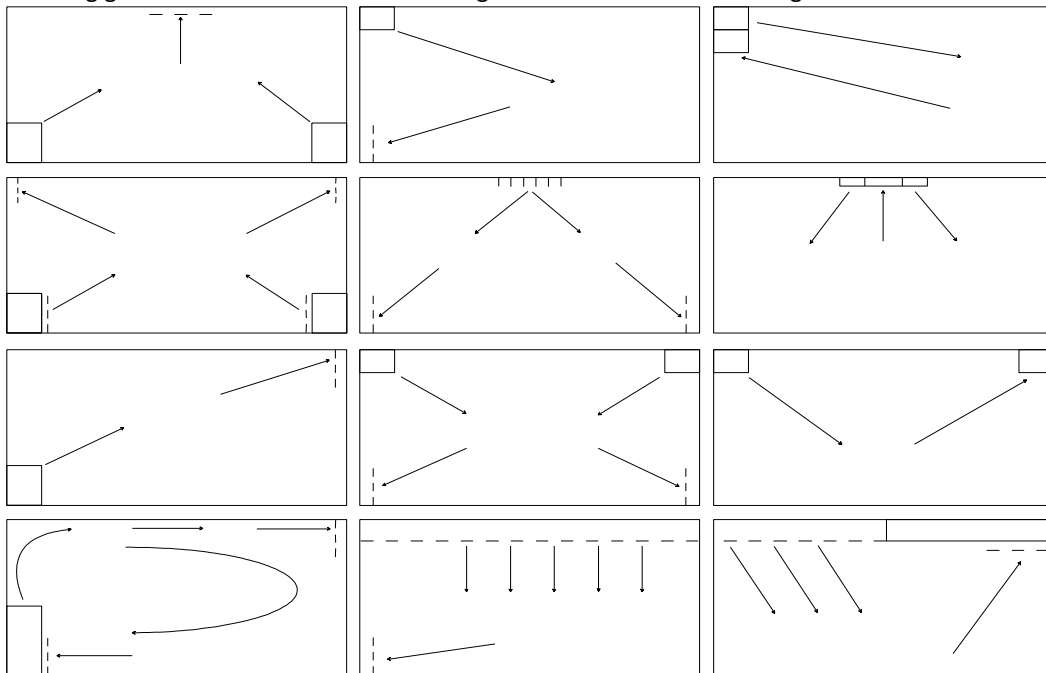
Wichtigste Formen der Luftführung in einem Raum
